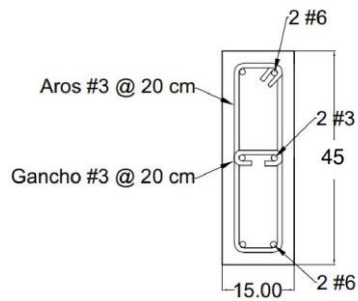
Detalle de refuerzo en viga corona de concreto.
